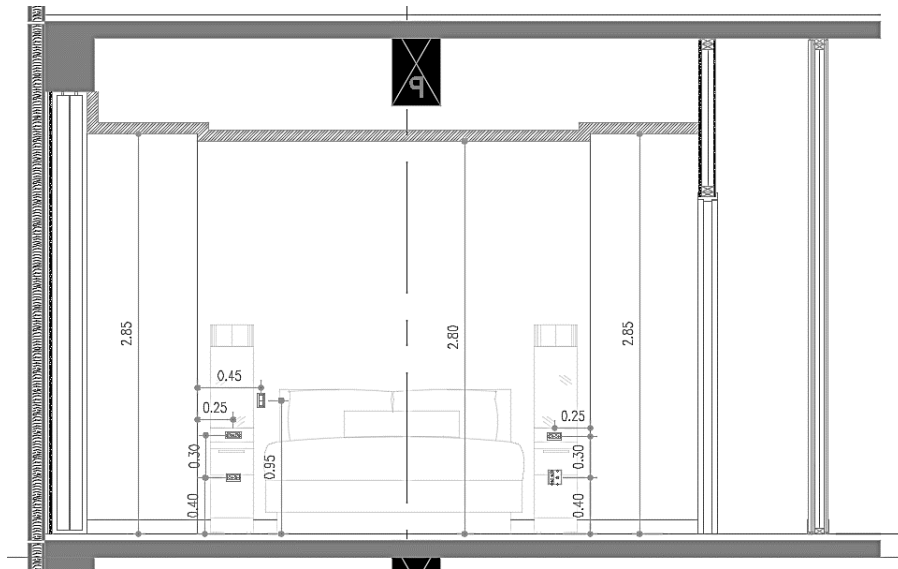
Elevación E-6 King Suite Hotel Courtyard
